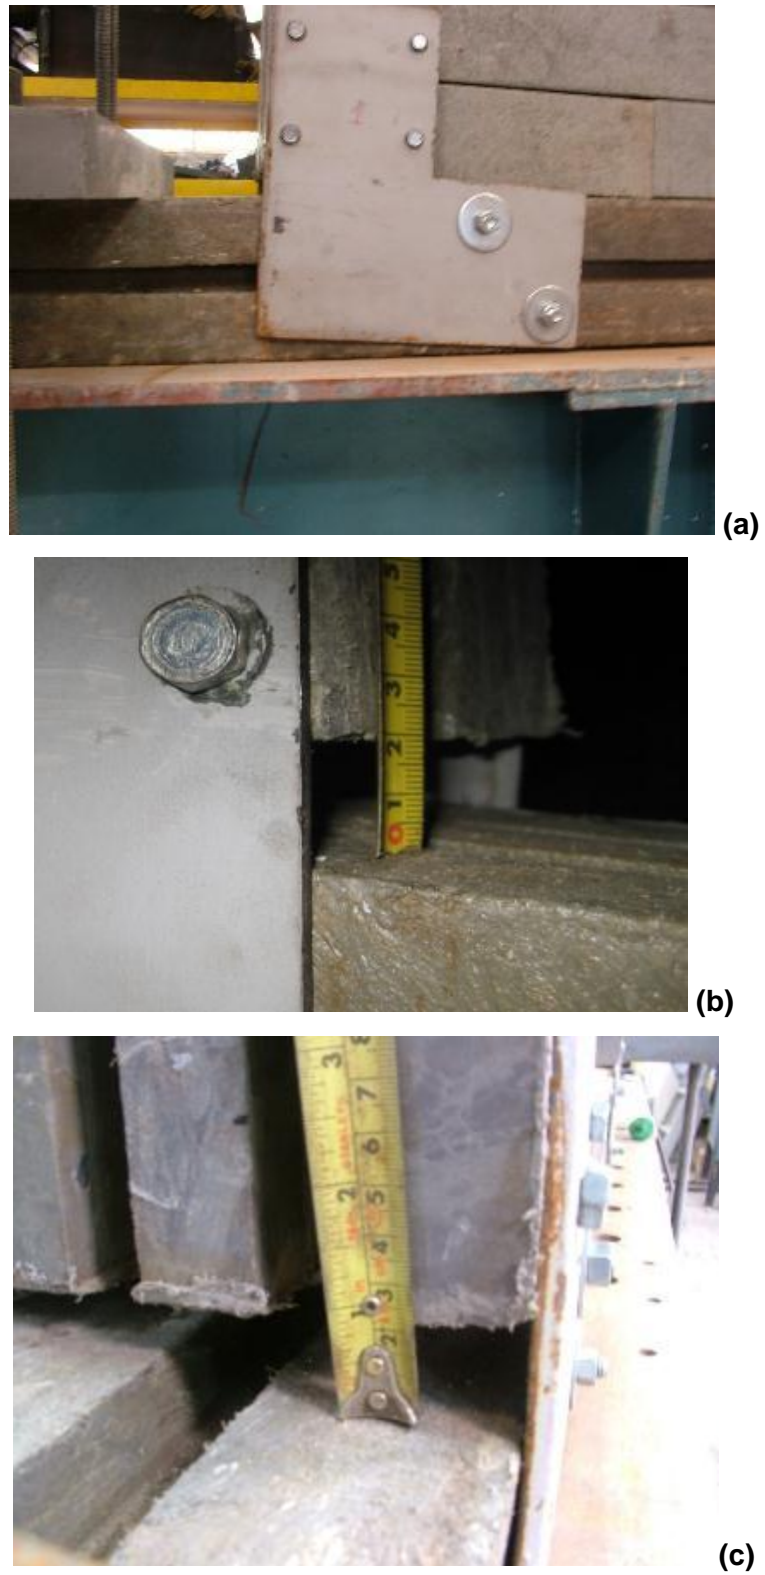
(a) (b) y (c) Detalle de giro en unión viga inferior - columna, muro a escala real sometido a fuerza cortante. Muestra 2. Fuente: Autor.
